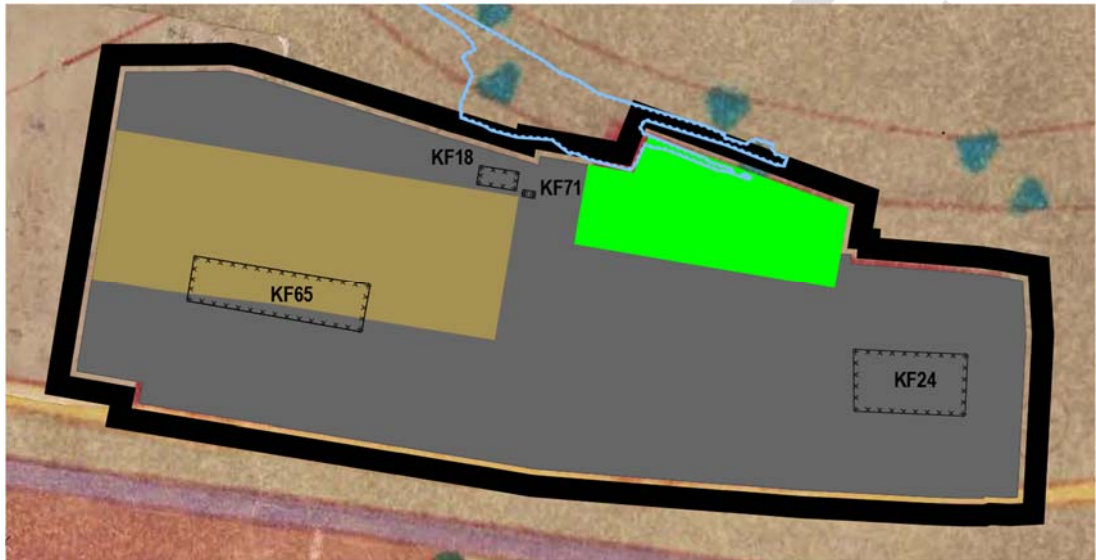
Plangebiet mit Bezeichnung der Kontaminationsflächen (Quelle: Stadt Würzburg)
